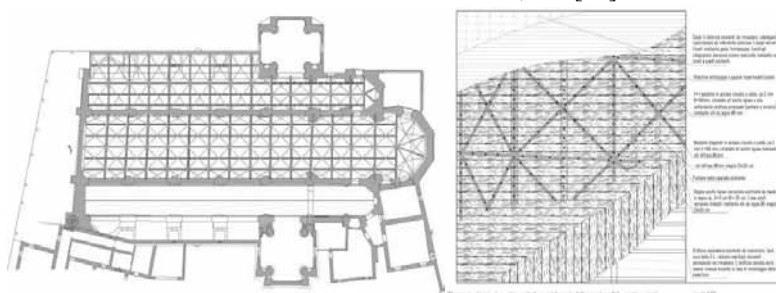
Disposizione delle bandelle sulla copertura della navata centrale e dettaglio stratigrafico d’intervento.
